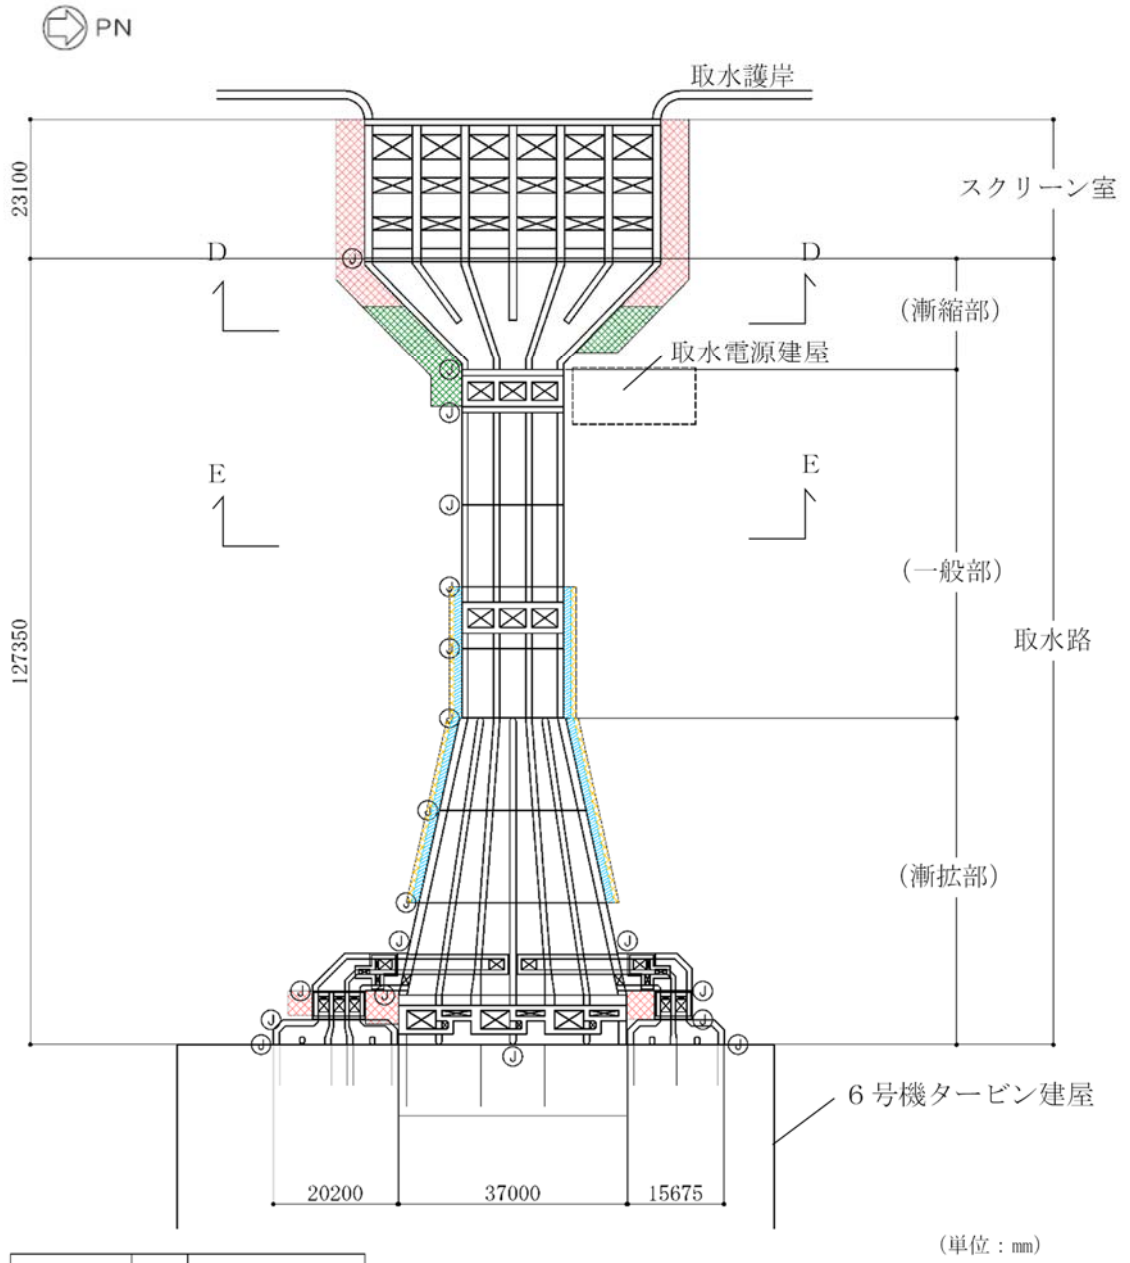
7号機 スクリーン室，取水路及び補機冷却用海水取水路の平面配置図
